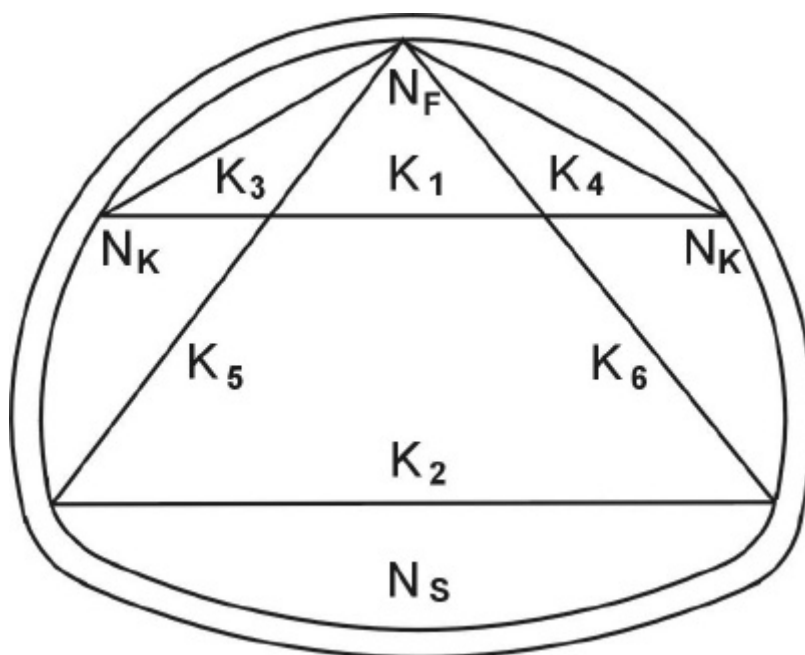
Section de mesure standard pour un tunnel avec avancement en calotte
